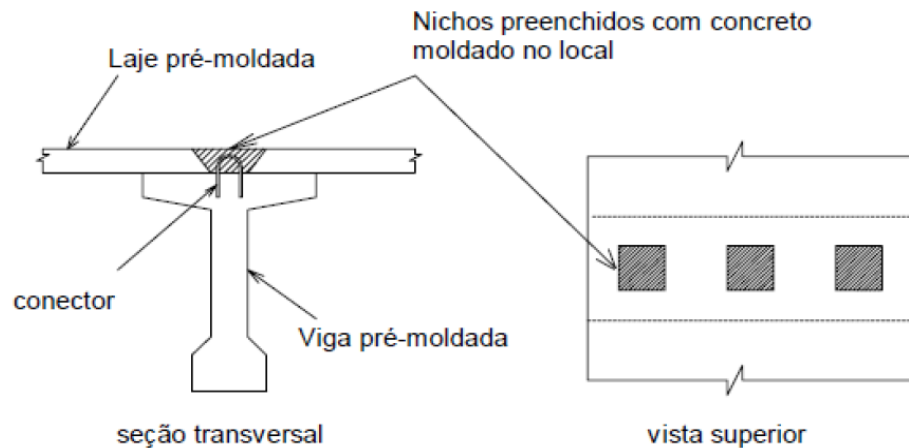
Ligação de longarinas pré-moldadas de concreto a laje. Fonte: Araújo (2002).
